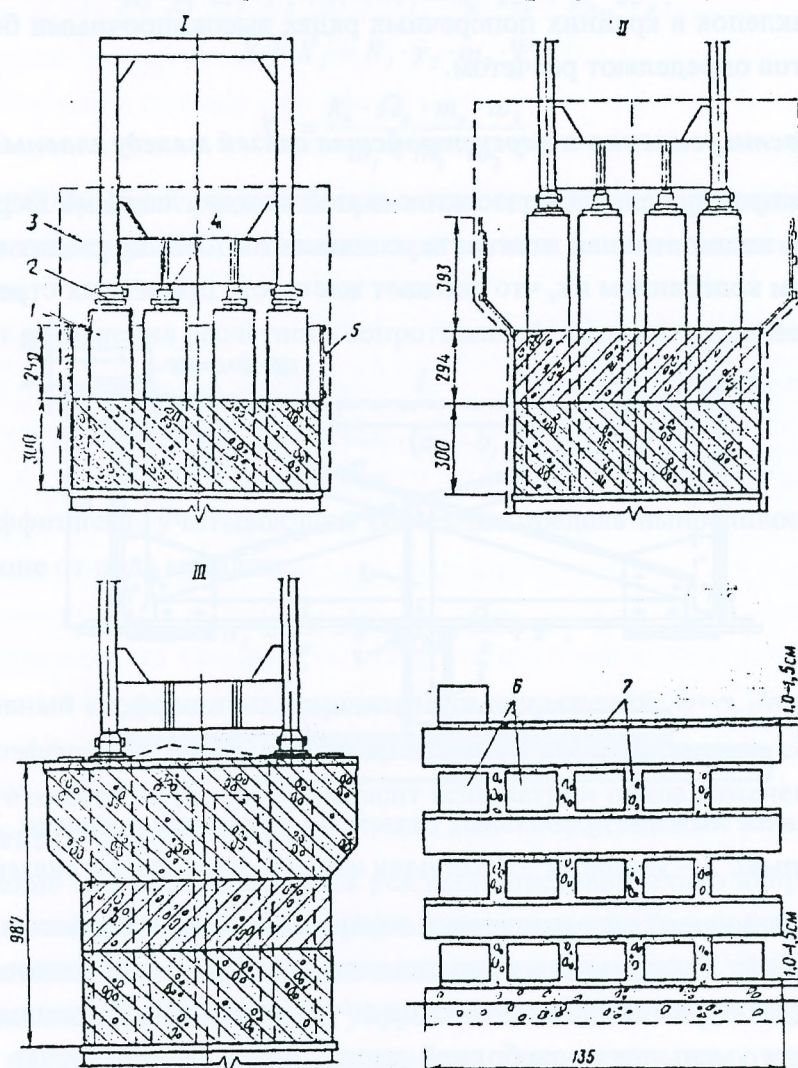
Схема подъемки пролетного строения и деталь клетки: I, II, III – стадии подъемки и бетонирования: 1 – клетка из железобетонных брусьев; 2 – пакет из рельсов; 3 – тепляк; 4 – гидравлический домкрат; 5 – опалубка; 6 – железобетонные брусья; 7 – цементный раствор.
